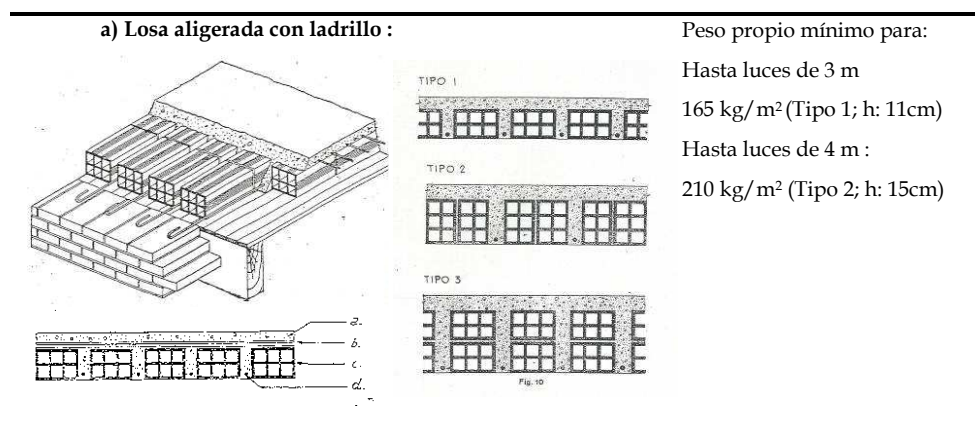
Tipología de forjados para losa de hormigón aligerada.
